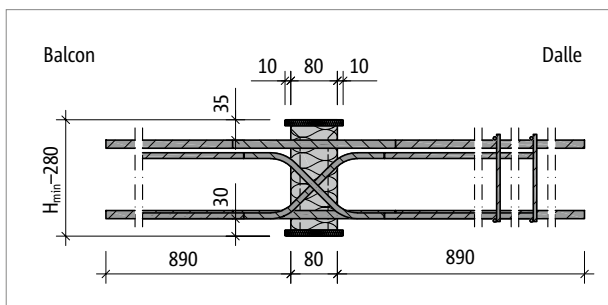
Schöck Isokorb® T type D-MM6-VV3 pour CV35 : coupe du produit
